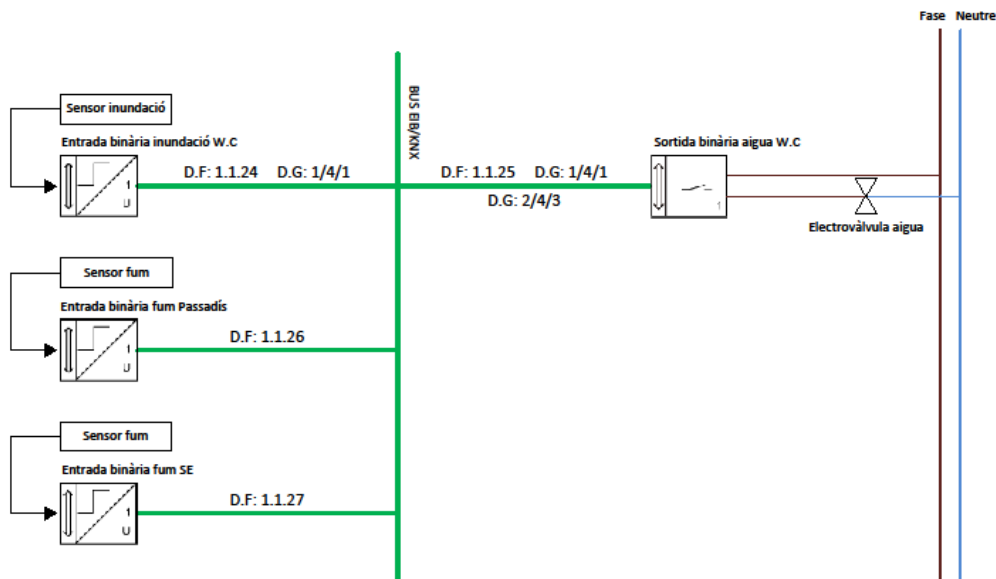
Esquema domòtic de seguretat planta subterrània
